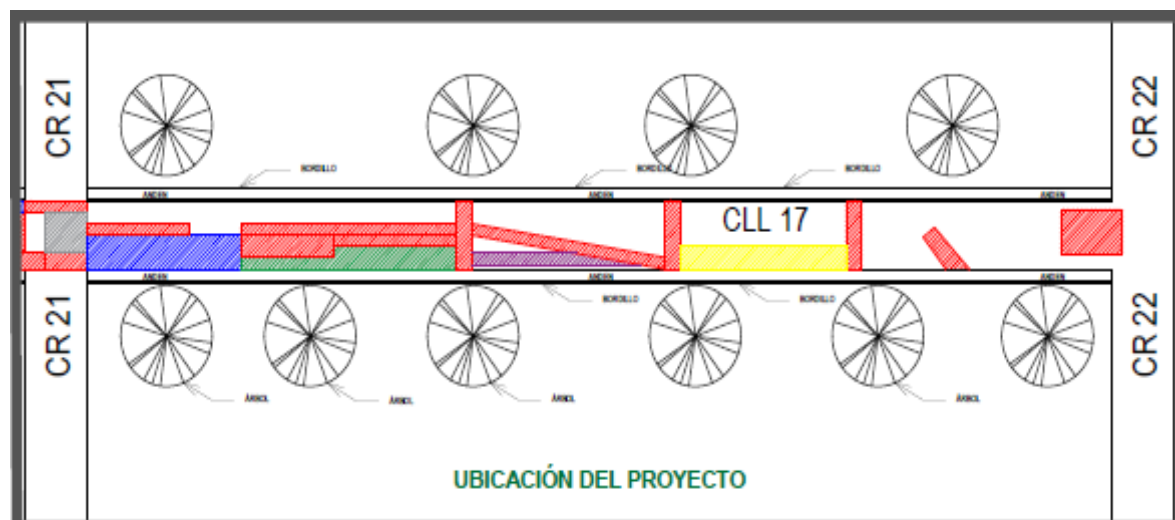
Plano de levantamiento de lesiones patológica que manifiesta la vía tramo 1
